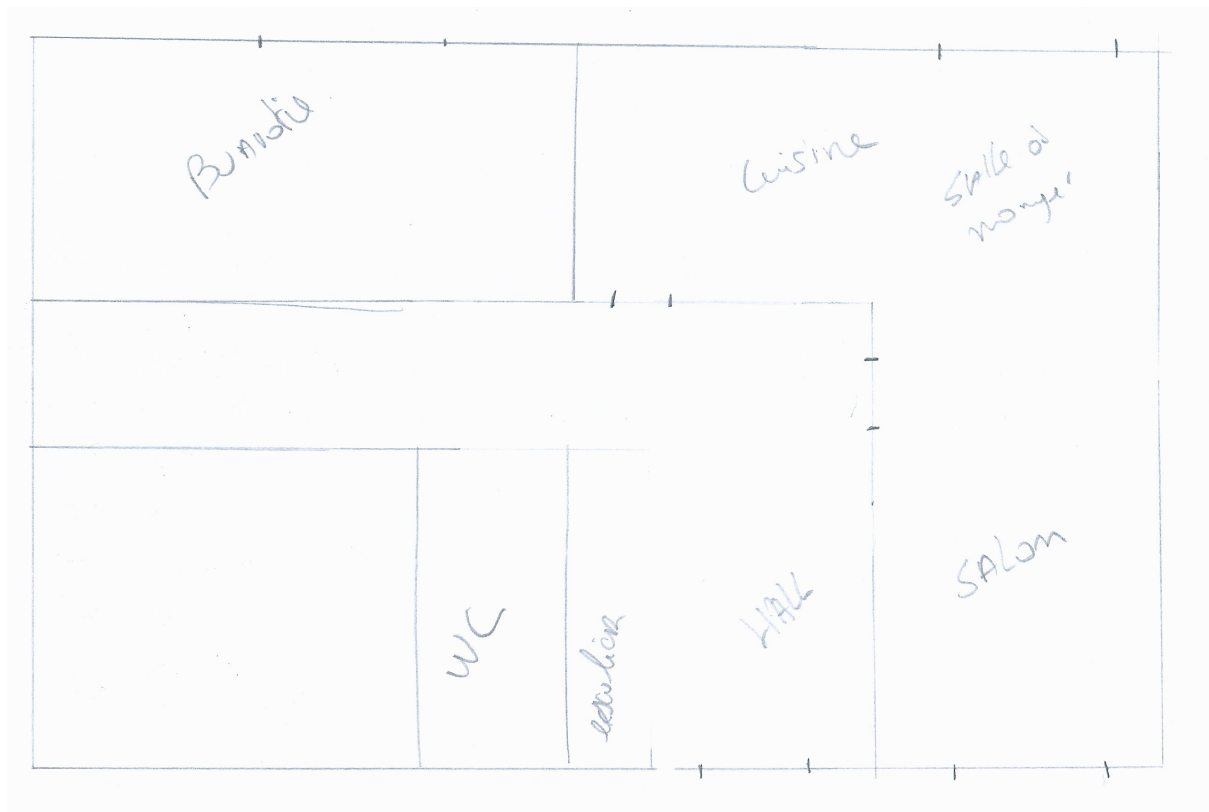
Plan du rez de chaussée réalisé lors de l'atelier V1
